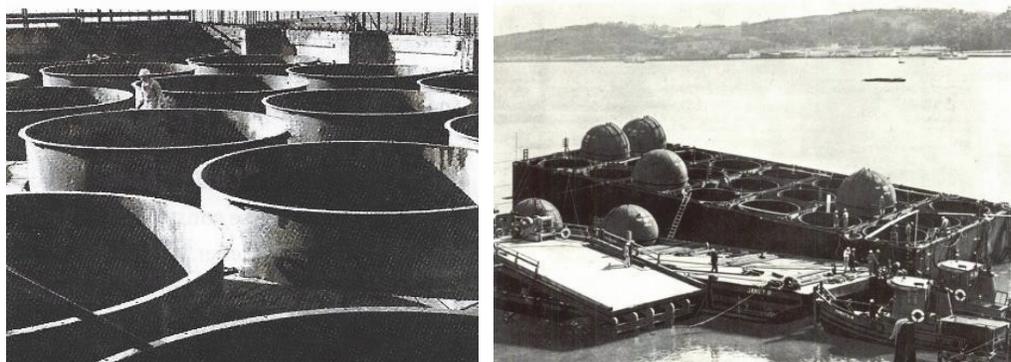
Seção flutuante de aço, fabricada em Vila Franca de Xira, destinada à construção das fundações da torre norte da ponte 25 de abril sobre o rio Tejo (capa da Revista Técnica 325, fevereiro 1963).
